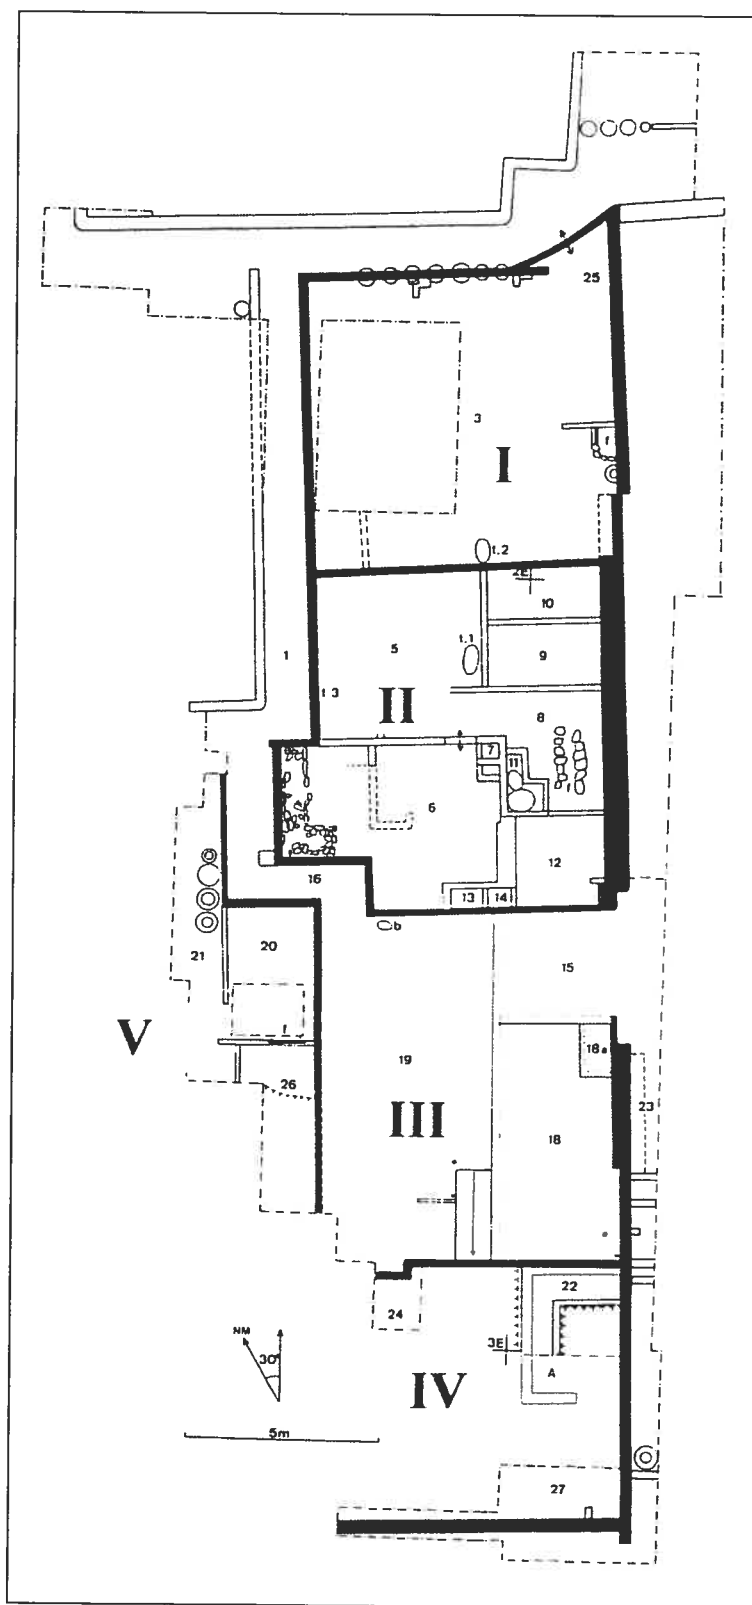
Plan des cinq secteurs du complexe architectural # 37
